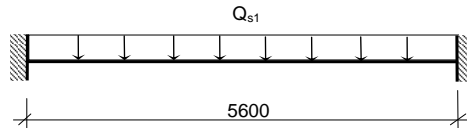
Розрахункова схема залізобетонної плити ПМ-1.
